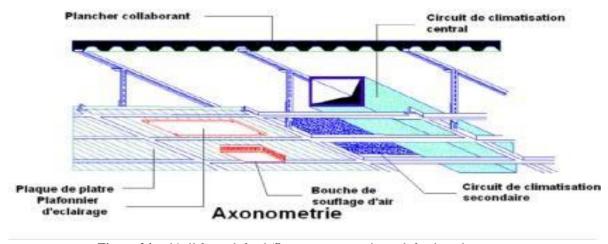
détail faux plafond /Source: www.artisan-plafond-tendu.com
